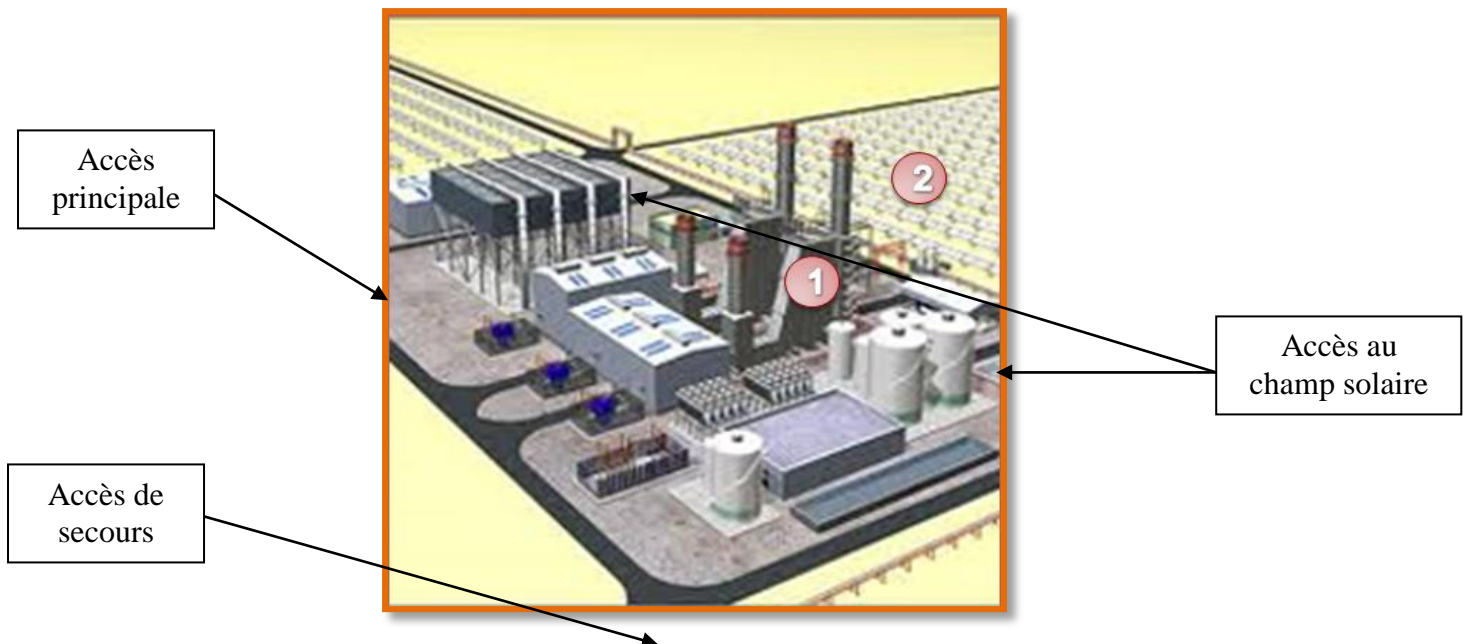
Plan d'implantation de la centrale de Hassi R'mel
